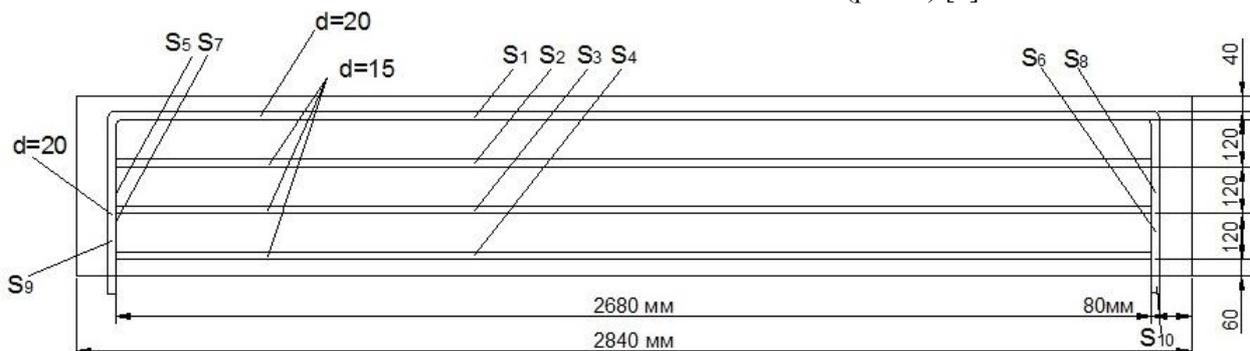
Расчетная схема бетонной отопительной панели с конвективным каналом.
